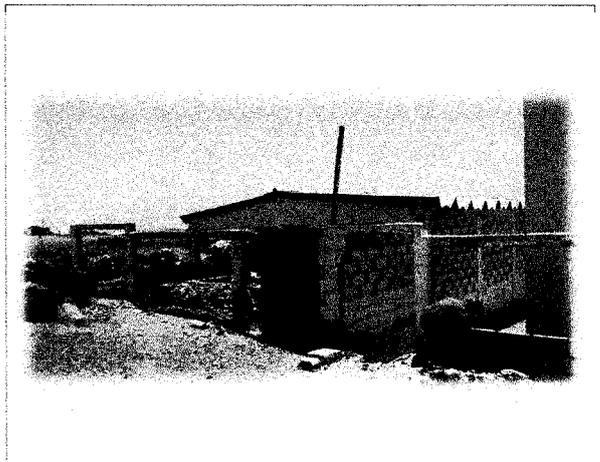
ASENTADO DE BLOQUES DE CONCRETO CERC PERIMETRICO
